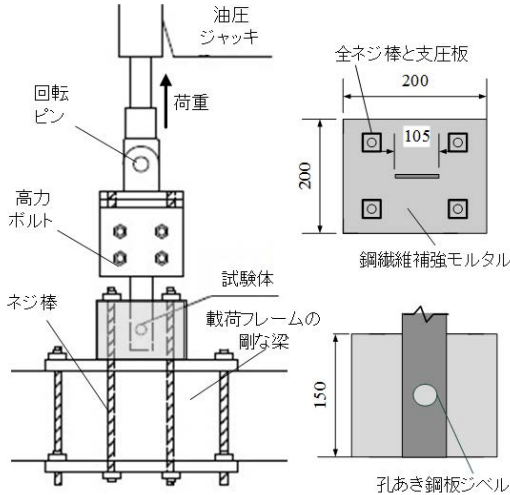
引抜き試験の設置状況（左側）と引抜き試験体（右側）
